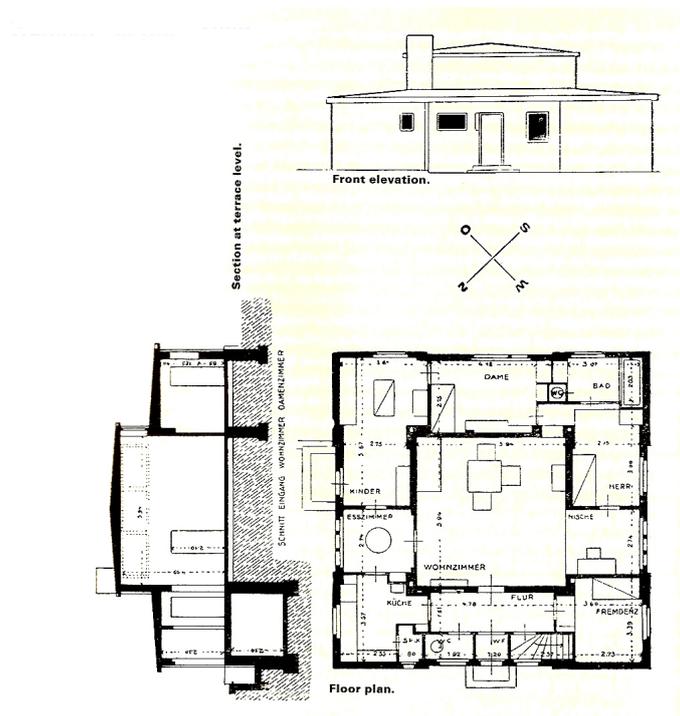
Walter Gropius - *Haus am Horn*, 1923. Alçado Principal, Corte e planta.
